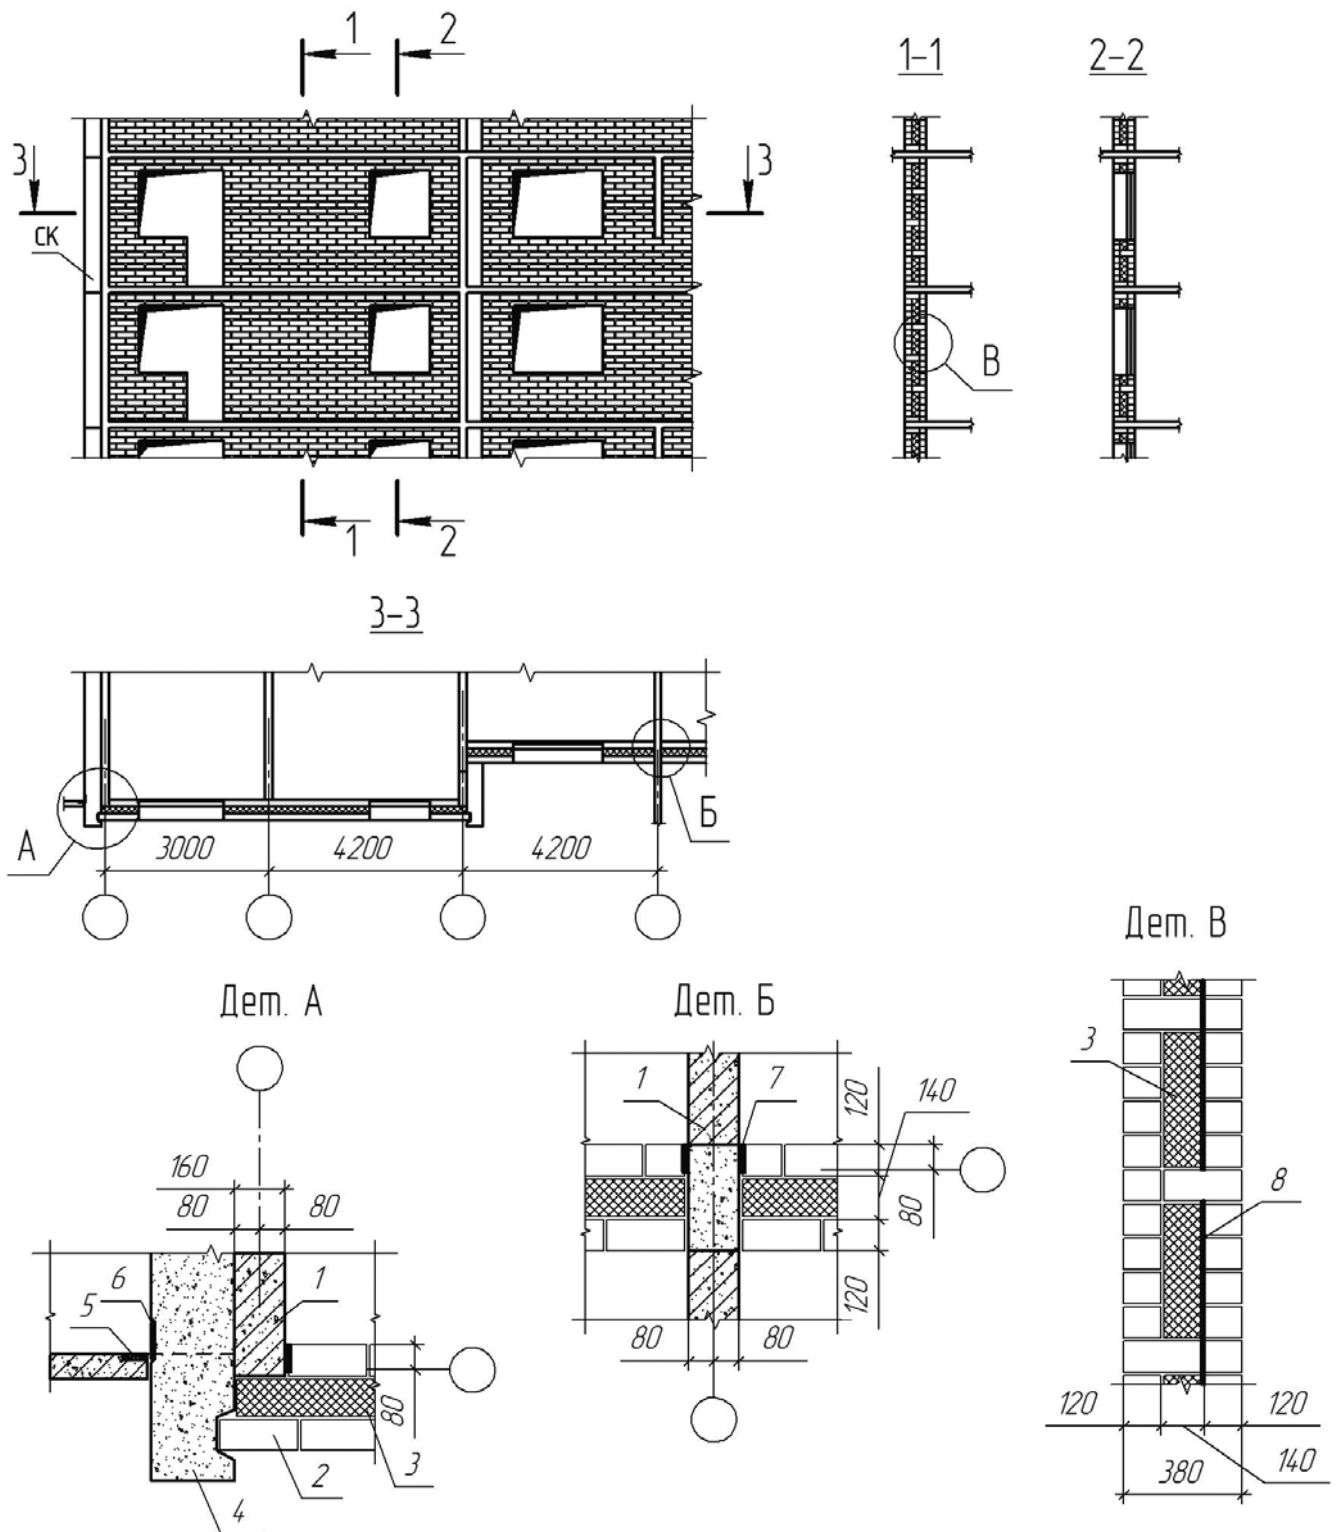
Кирпичная наружная стена монолитного здания (фрагмент фасада и конструктивные узлы):
